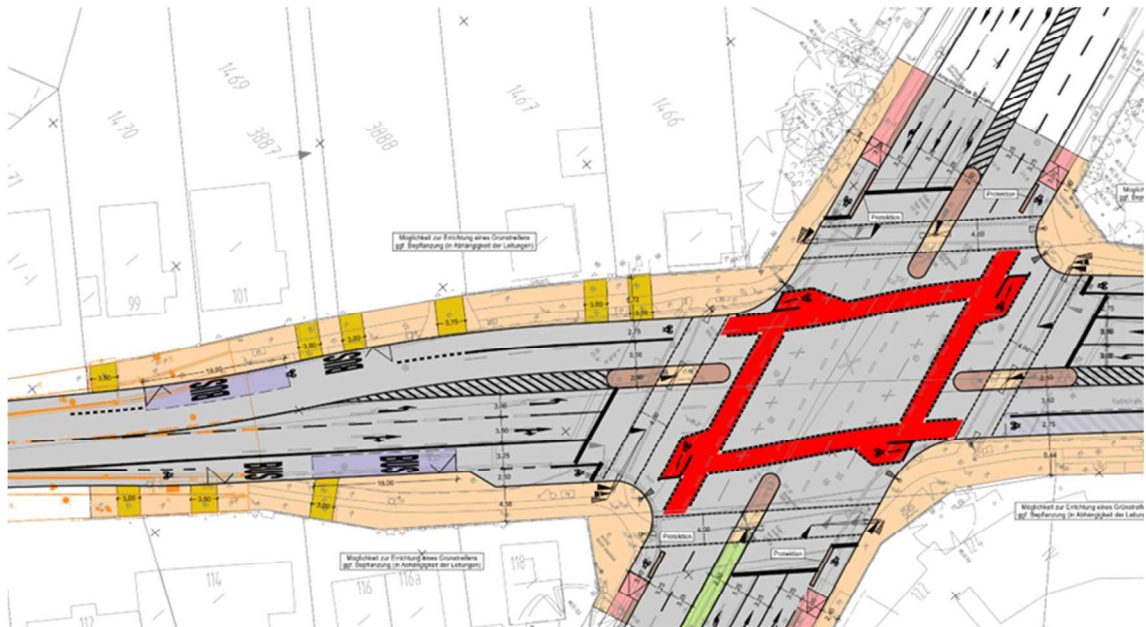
Lageplan Variante 3 (Ausschnitt)
